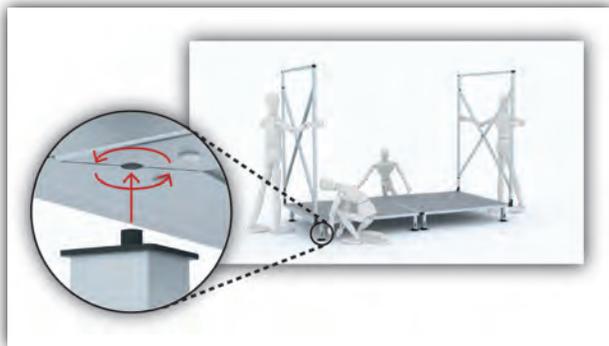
Levantamiento del suelo del conjunto piso - paredes laterales y detalle de colocación de patas niveladoras.
